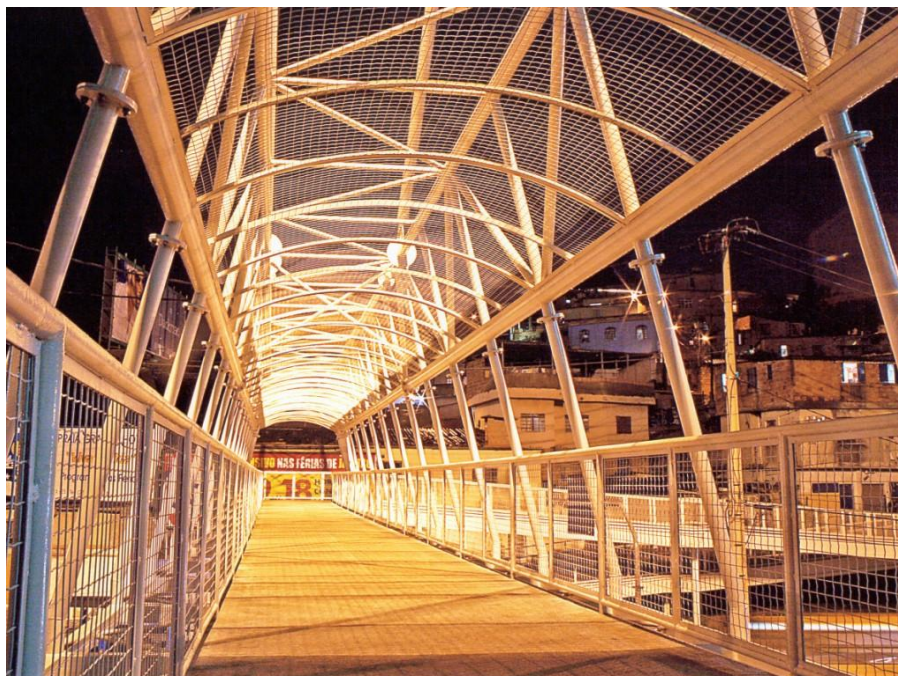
Exemplo de passarela metálica em estrutura tubular. (V&M do Brasil, 2008)
